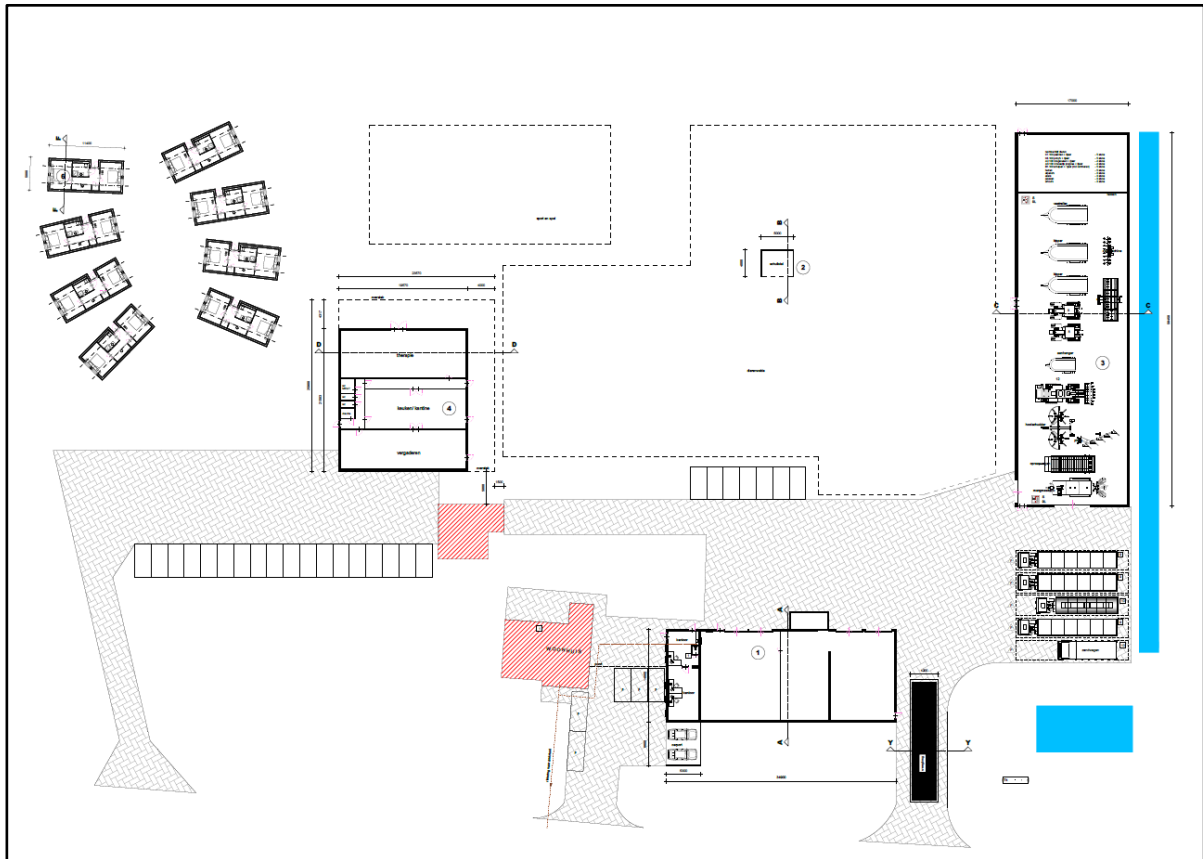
Uitsnede planlocatie uit bestemmingsplan
